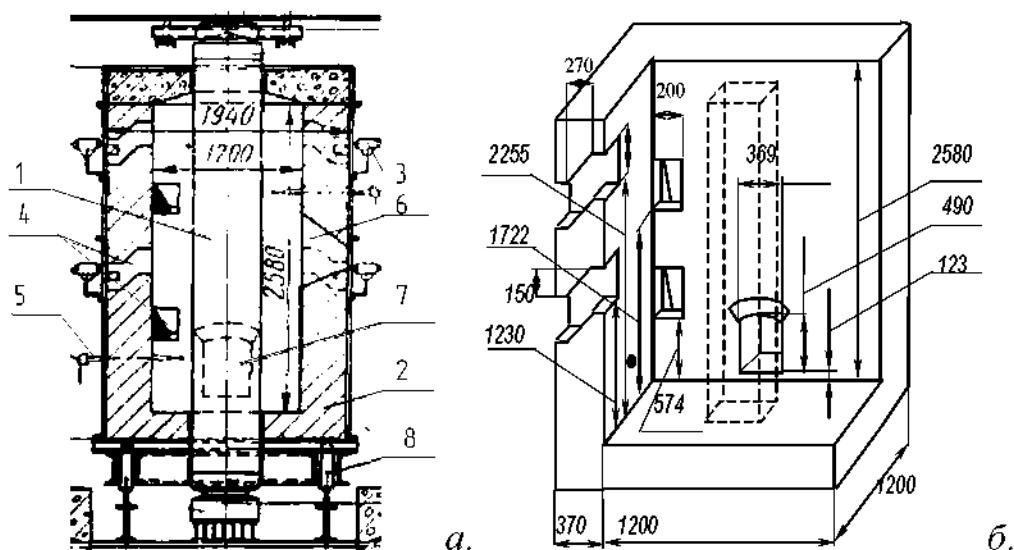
Огневая печь для испытаний железобетонных колонн на огнестойкость: а – чертеж фрагмента установки с огневой печью; б – геометрия огневой печи с установленной в ней колонной
